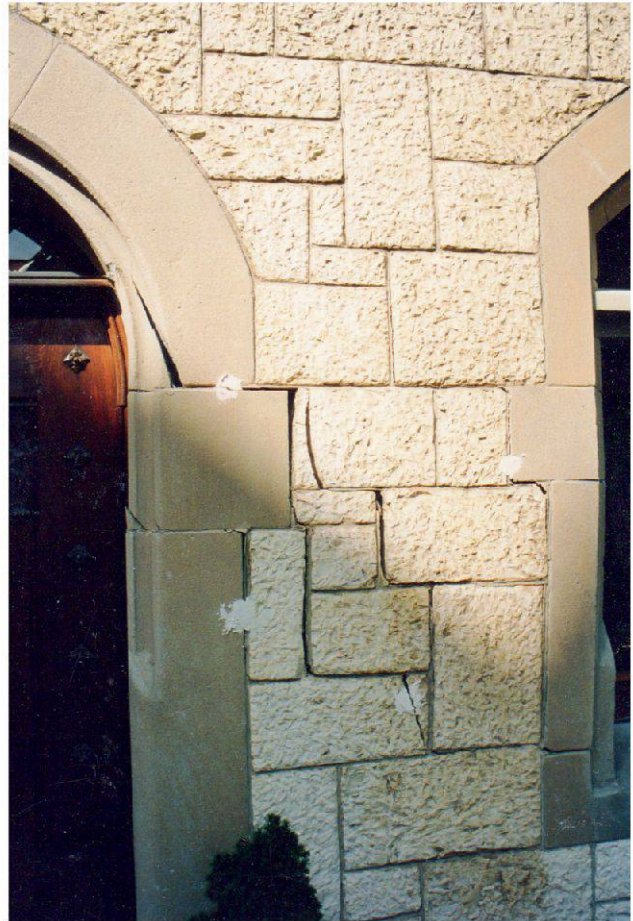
Setzungsschäden und erste Sanierungsmassnahmen an einem denkmalgeschützten Haus, Steigstrasse, Schaffhausen (Fotos S. Frank).
